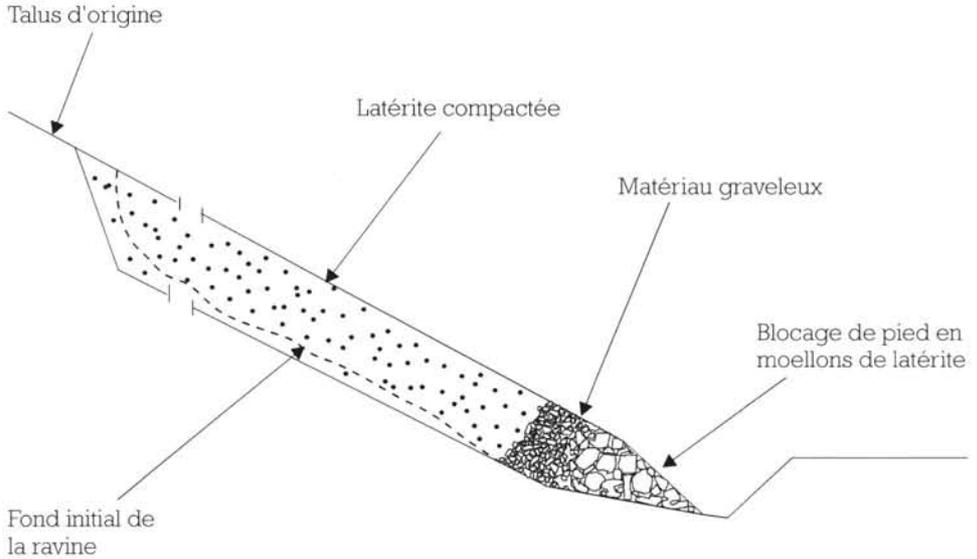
Principe de réparation d'une ravine (coupe longitudinale).
